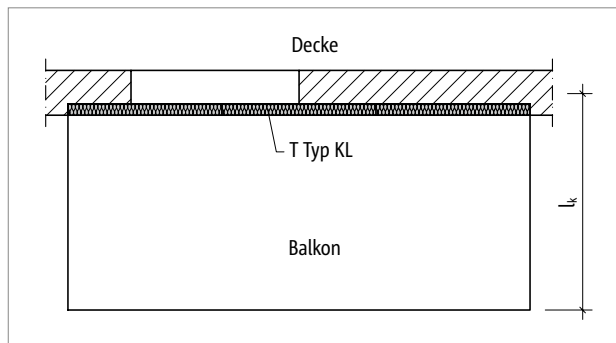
Schöck Isokorb® T Typ KL: Balkon frei ausragend
